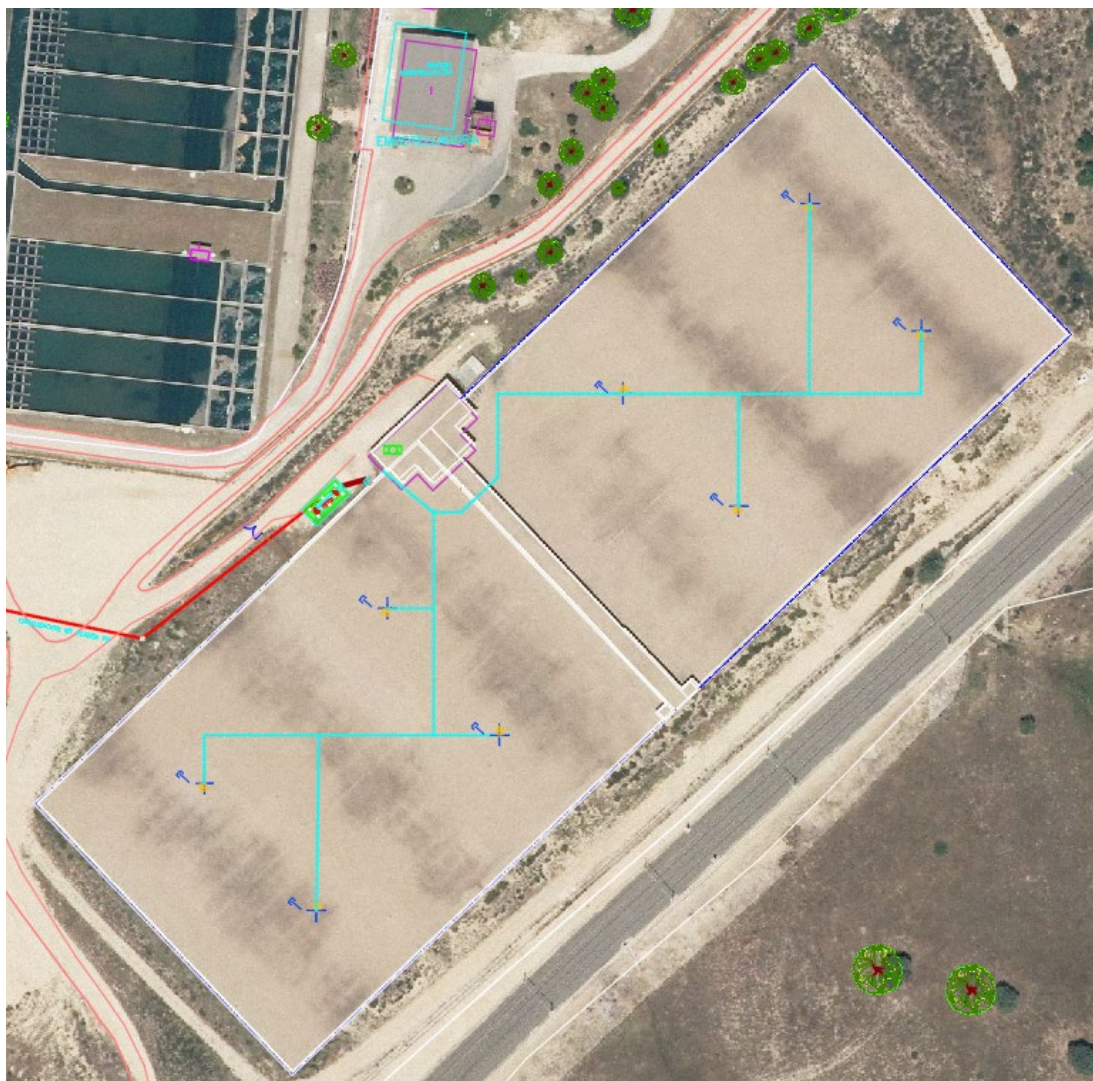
Plano de sistema de limpieza de la planta fotovoltaica.
